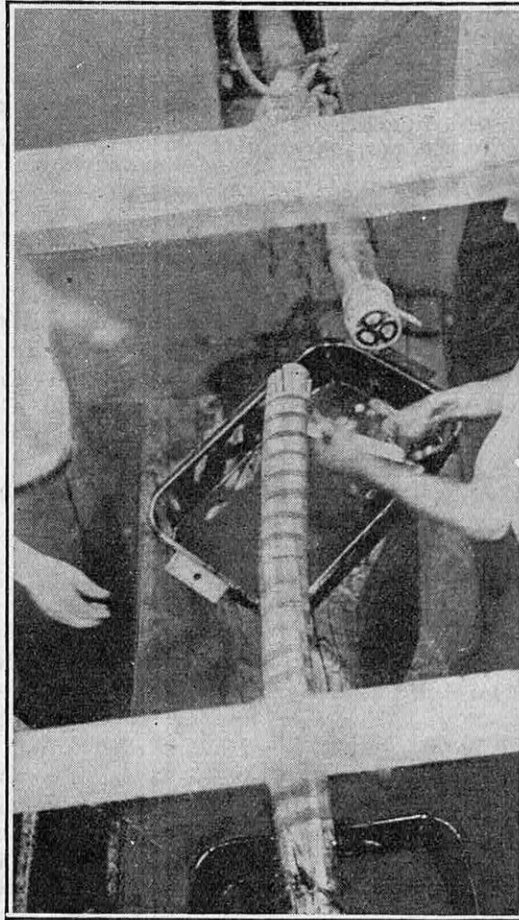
ÉTABLISSEMENT D'UNE CONNEXION ENTRE DEUX SECTIONS D'UN CÂBLE A HUILE
